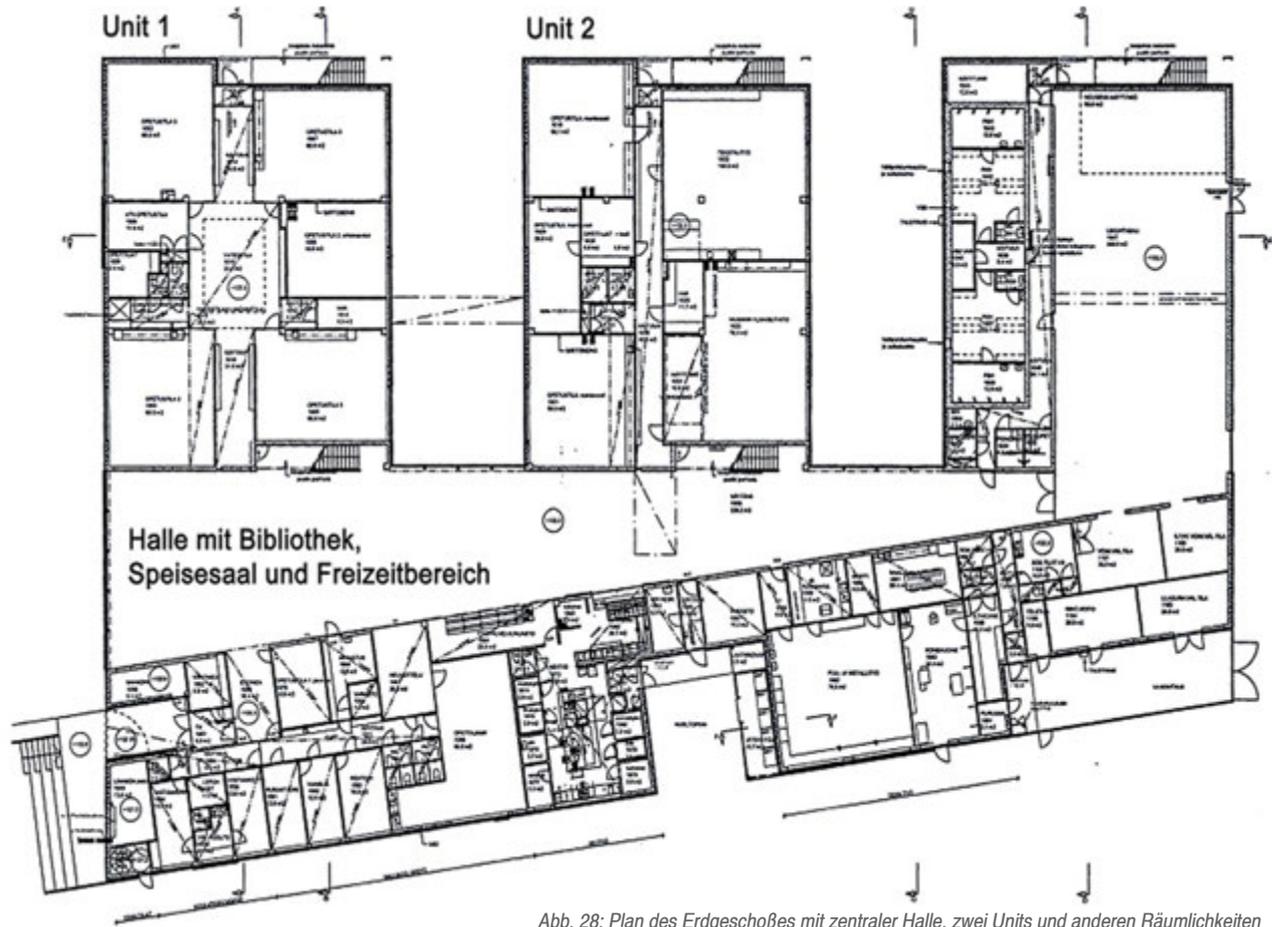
Plan des Erdgeschoßes mit zentraler Halle, zwei Units und anderen Räumlichkeiten
